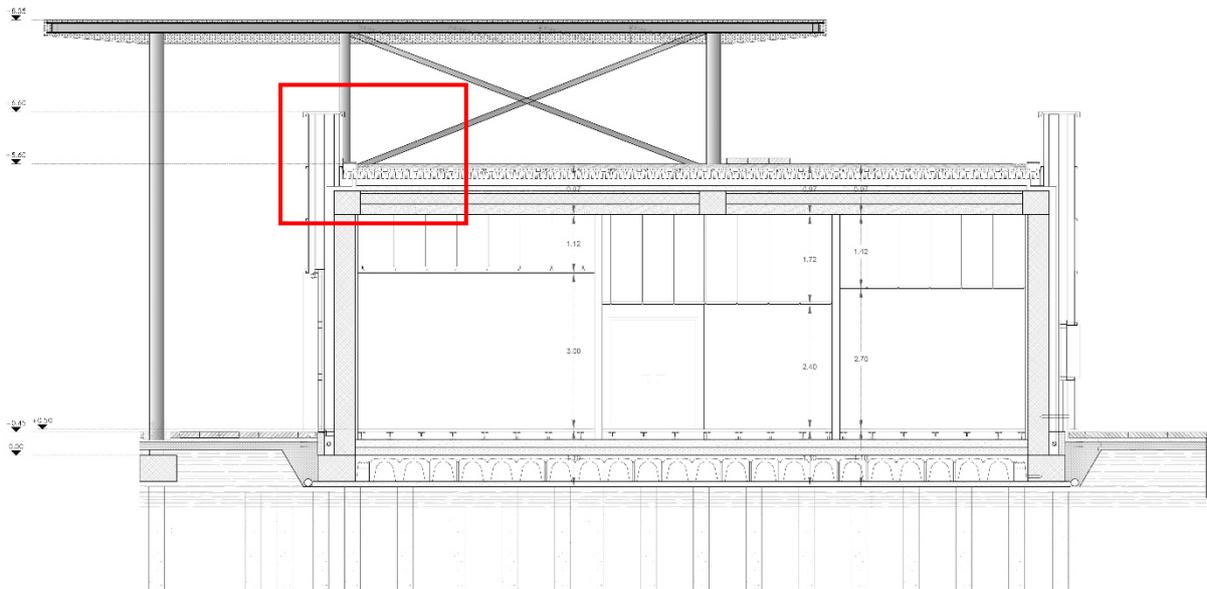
, 12 - Nuova palazzina uffici, sezione trasversale e dettaglio costruttivo copertura piana drenante in ghiaio lavato.
